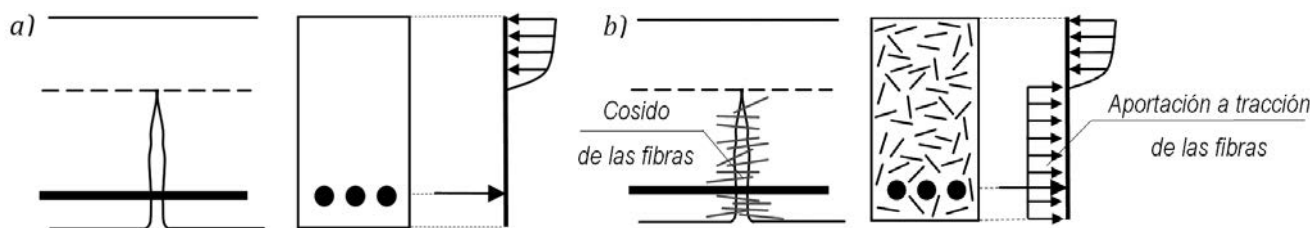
Distribución de tensiones para una sección: a) de HA y b) HRF con armadura. [5]
